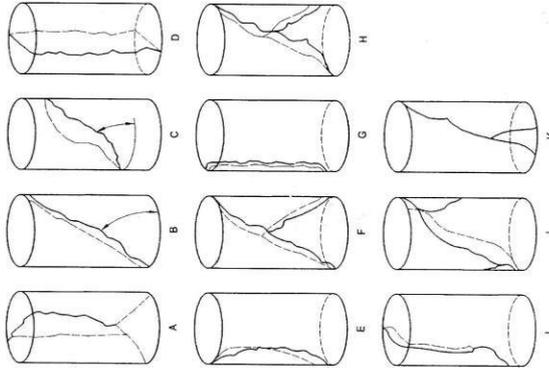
Exemples de ruptures incorrectes d'éprouvettes cylindriques
